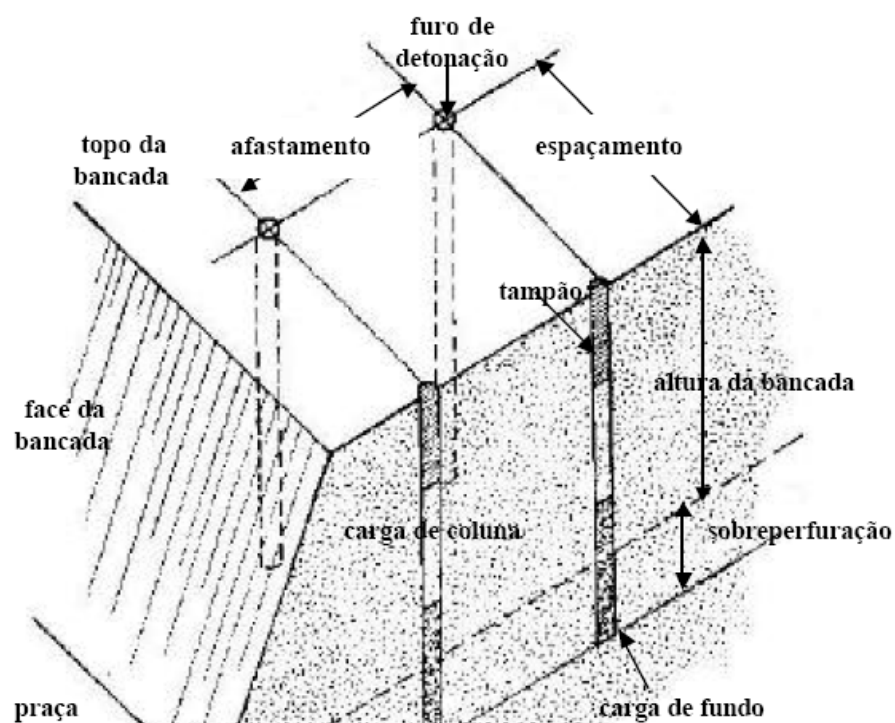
Geometria dos elementos num plano de fogo (modificado – Wyllie & Mah, 2003).
